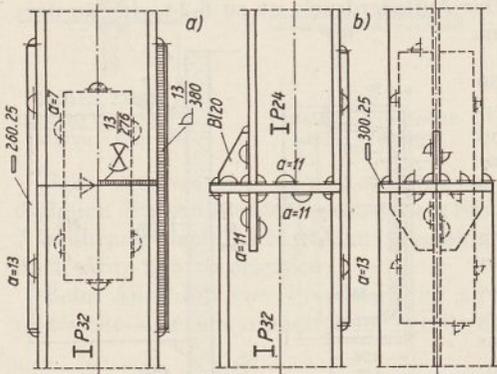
a u. b. Geschweißte Stützenstöße.
